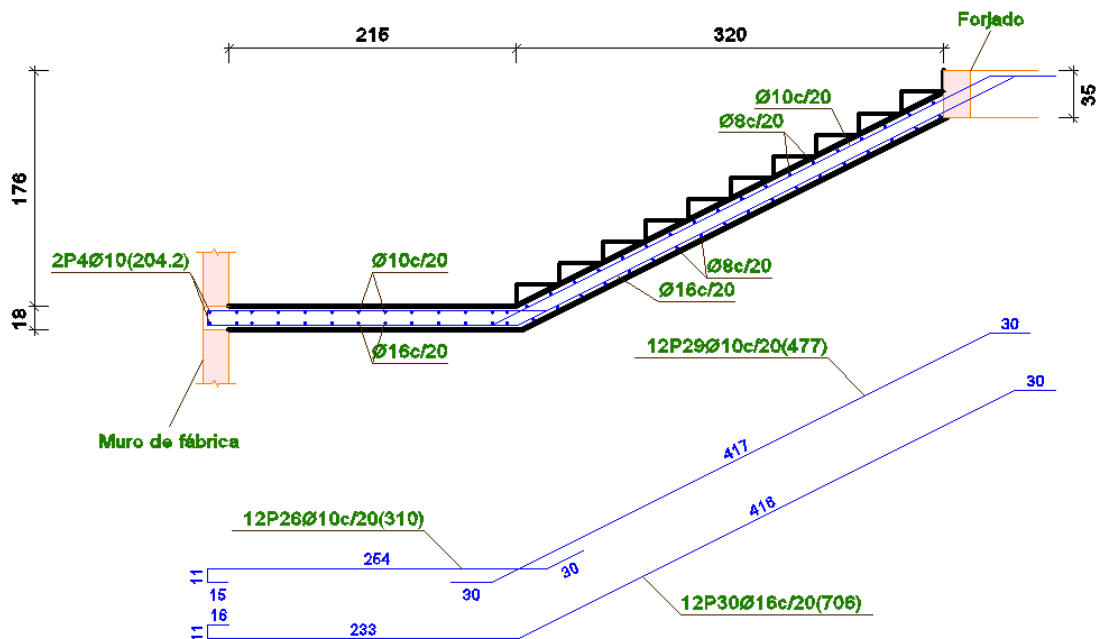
Despiece de Armadura; Elaboracion Propia
